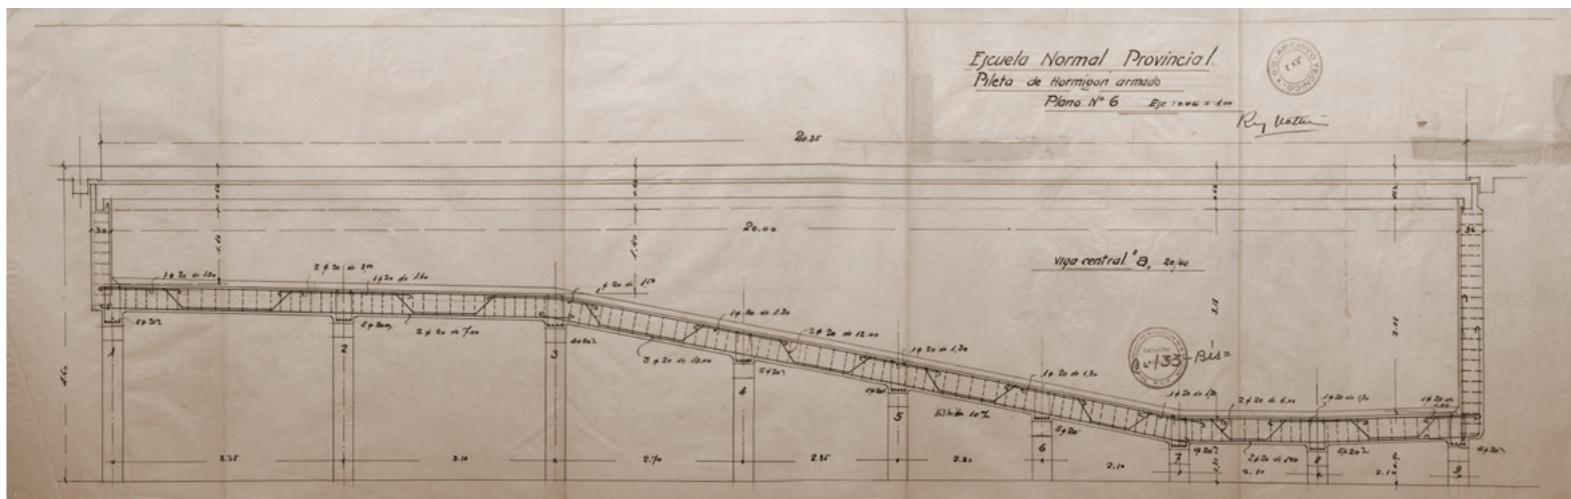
ENSC. Plano de la estructura de hormigón armado de la pista (Archivo de la Secretaría de Arquitectura de la Provincia de Córdoba).
